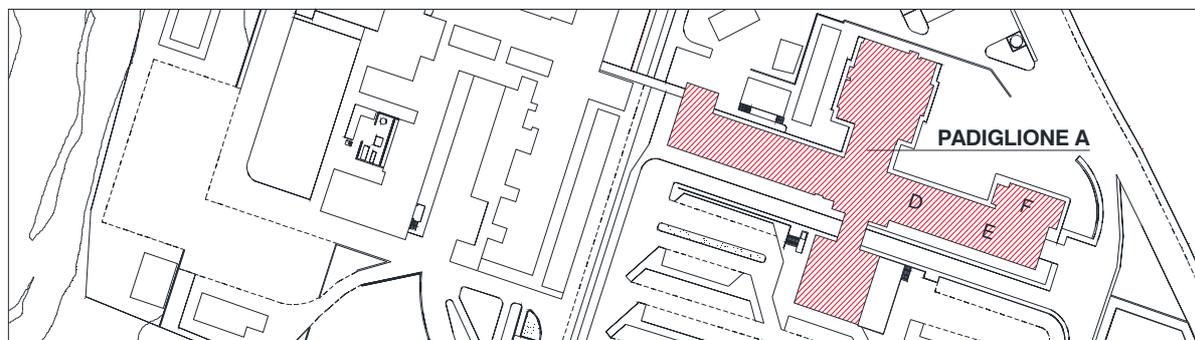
Stralcio planimetrico dell’area ospedaliera con ubicazione dell’attuale Pronto Soccorso Adulti
